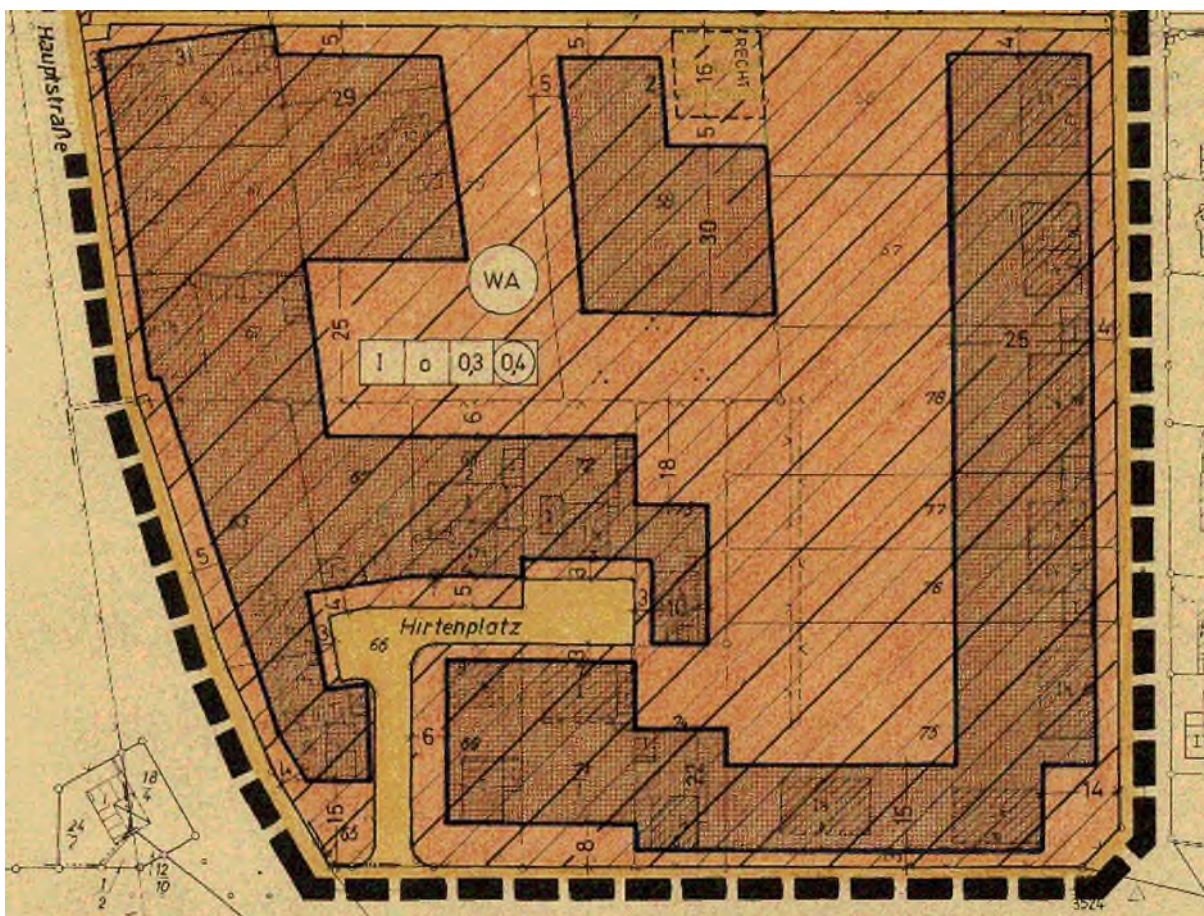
Teilausschnitt B-Plan Nr. 418
